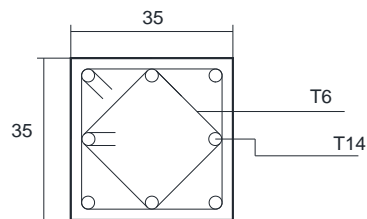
Ferrailage d'un poteau 35x35cm (poutres normales - plancher au dalles pleines)
